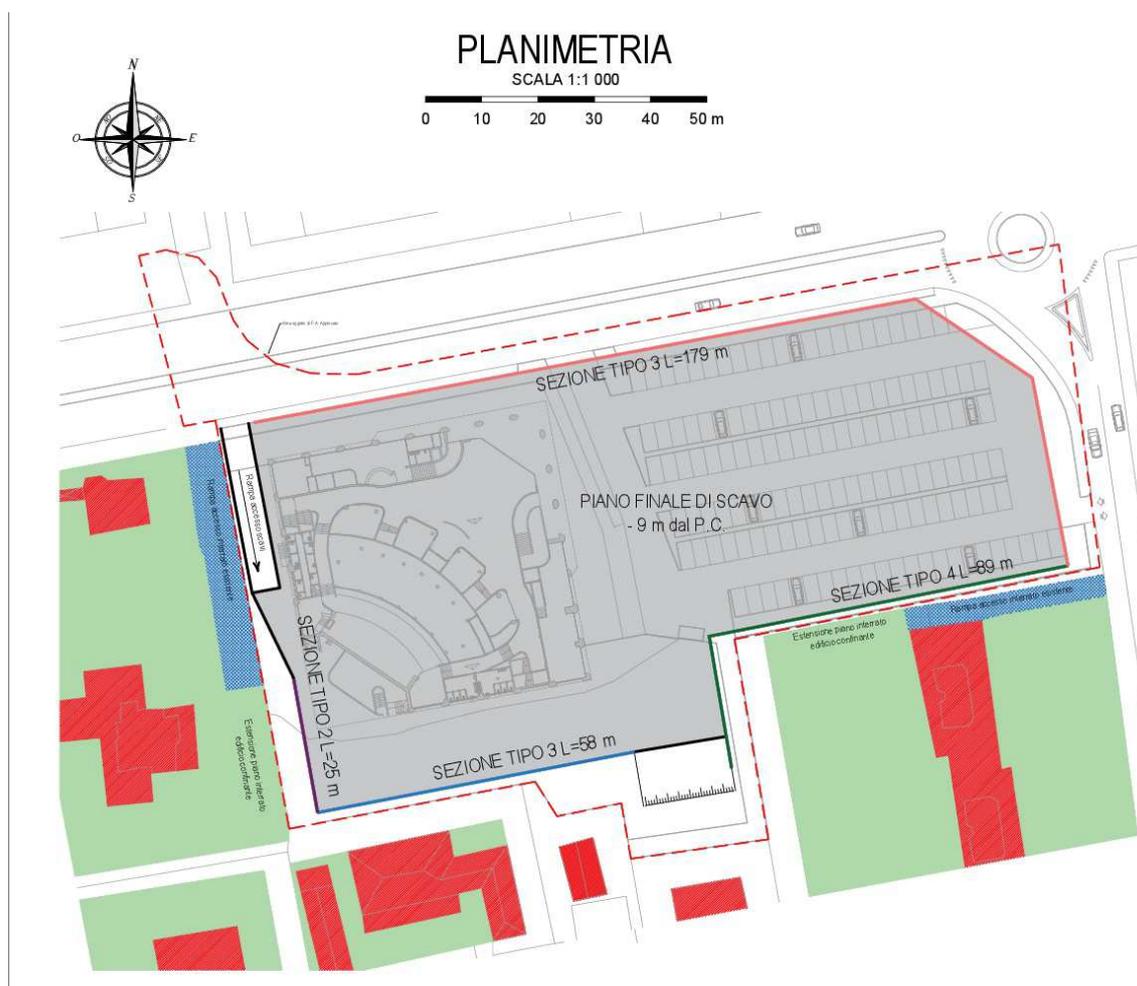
Planimetria delle opere provvisorie di sostegno dei fronti di scavo con ubicazione delle sezioni tipo.
